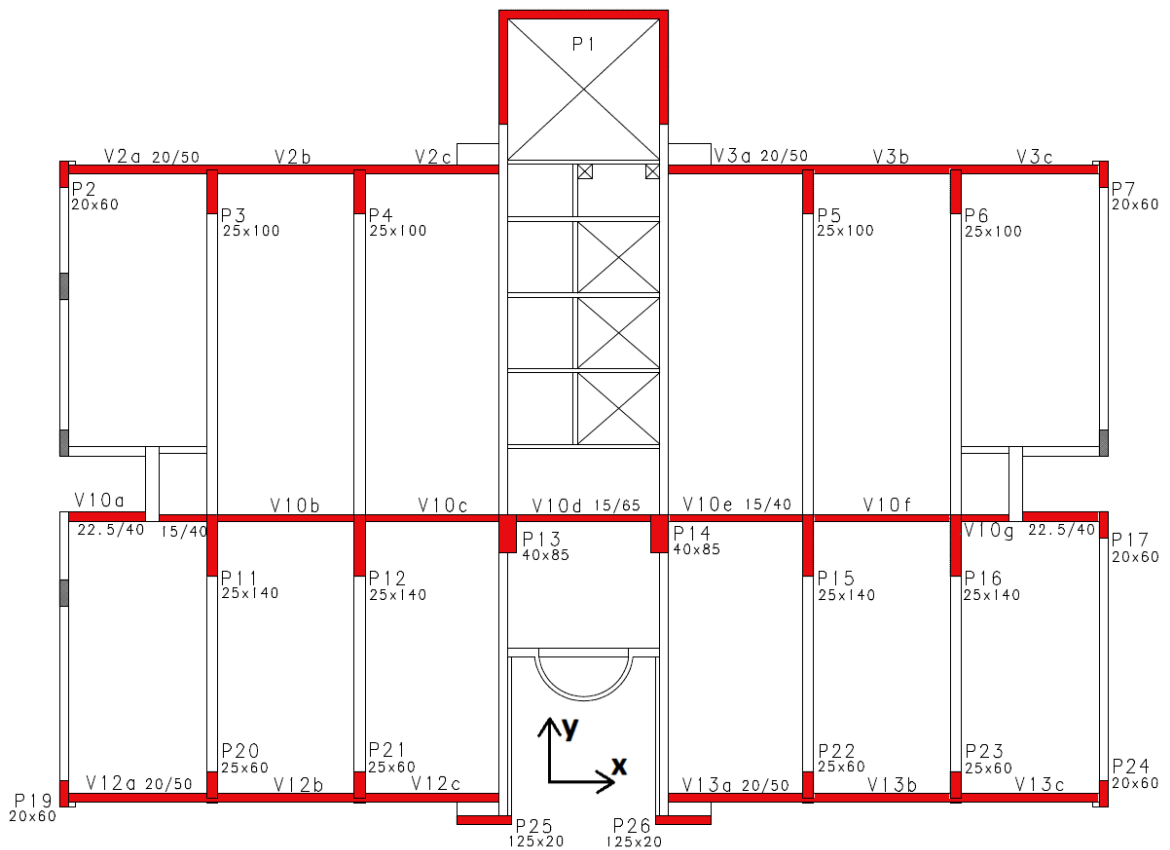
Indicação dos cinco pórticos planos e direções ortogonais sobre a planta do pavimento tipo que possui maior repetição.
